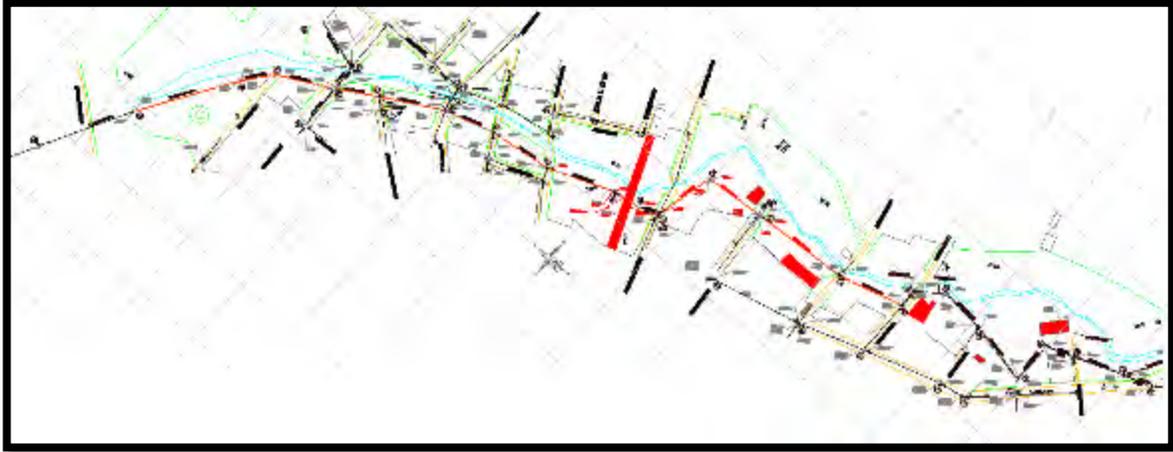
Planta de la red de alcantarillado Santa Librada tramo 1 – Barranquillita.
